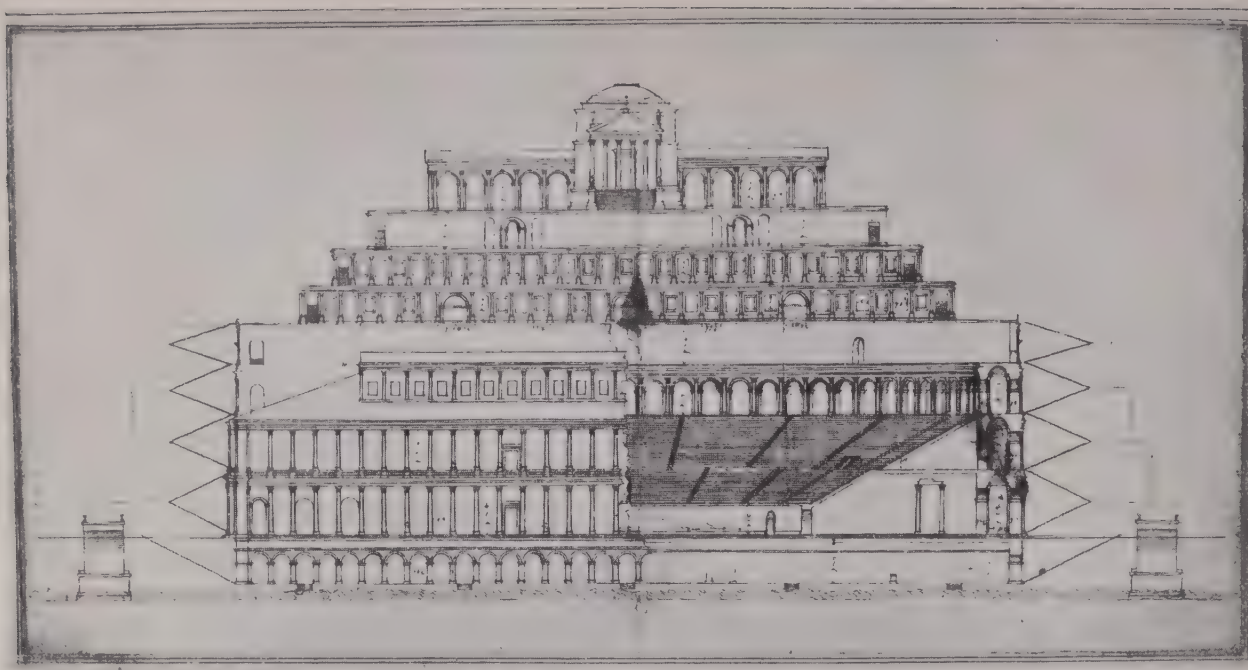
Palladio: Teatro Romano a Verona - Prospetto completo (Fot. Franco)
